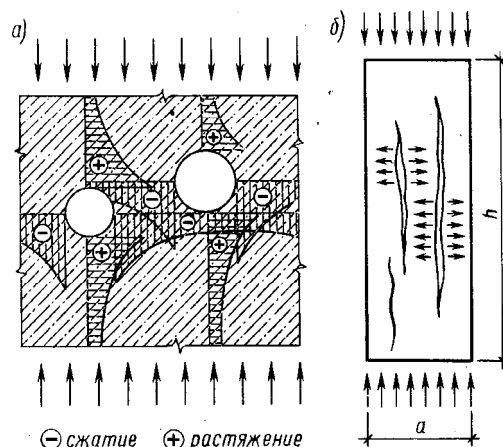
Схема напряженного состояния сжатого бетонного образца
